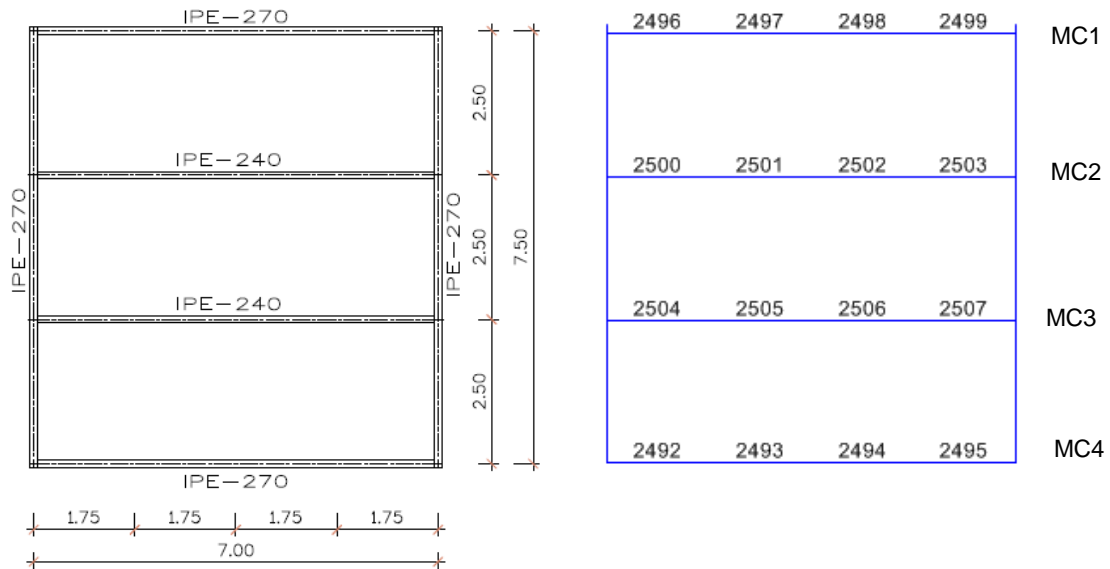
Planta com a Geometria e Identificação das Vigas da Cobertura 1.
